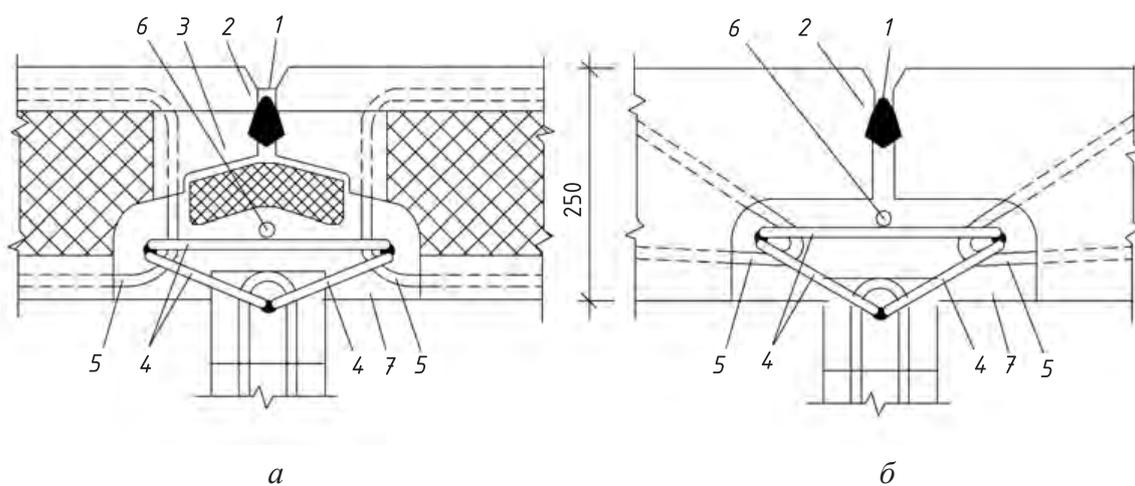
Конструкции вертикальных замоноличенных армированных стыков наружных стеновых панелей: *а* — трехслойных; *б* — однослойных керамзитобетонных: 1 — уплотнительная мастика (герметик); 2 — прокладка из гернита или поронзола; 3 — вкладыш из минераловатных плит, обернутый в полиэтиленовую пленку, или вкладыш из пенопласта; 4 — скобы диаметром 12 мм; 5 — арматурные петли; 6 — анкер диаметром 12 мм; 7 — тяжелый бетон М150
